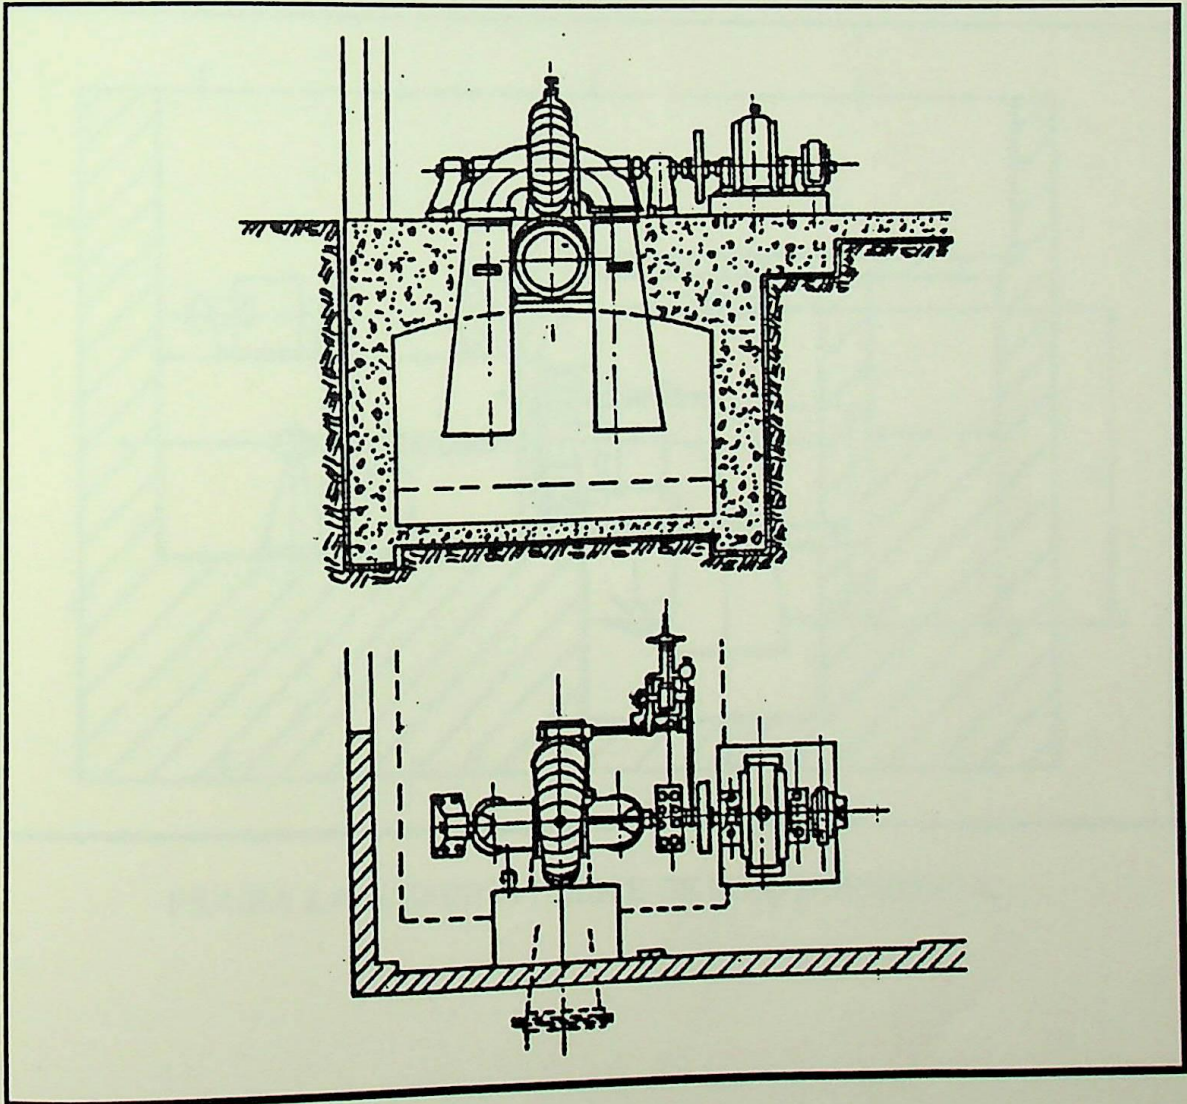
TURBINA FRANCIS ROTOR DUPLO OU GEMEO
